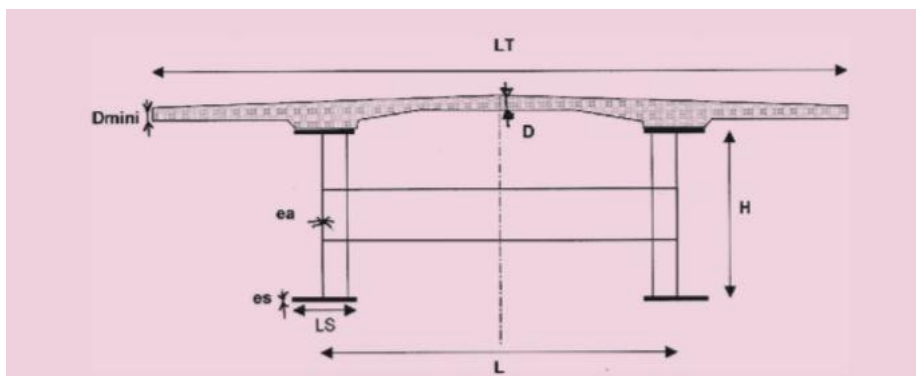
paramètres de pré-dimensionnement du tablier bipoutre [8].
